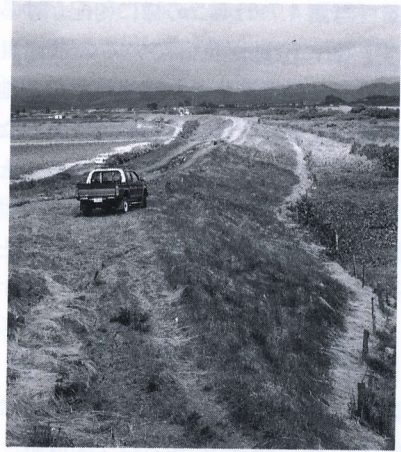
写真 4.8.3 と同じ地点で橋の直上流部の堤防
